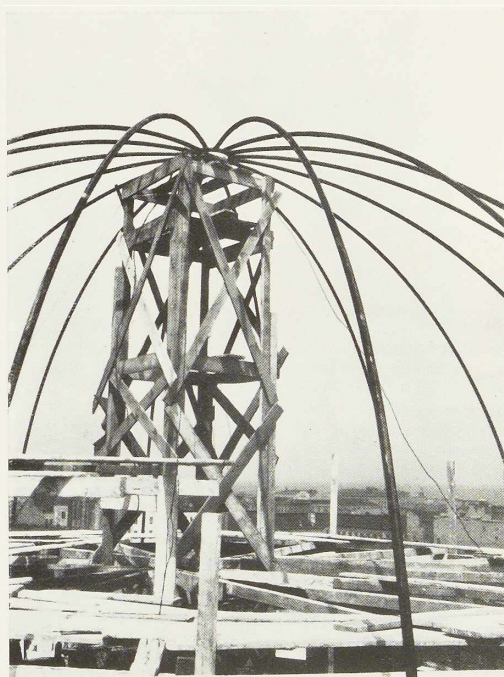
La coupole en tubes soudés de la Caisse d'Épargne de Varsovie en cours d'exécution.
